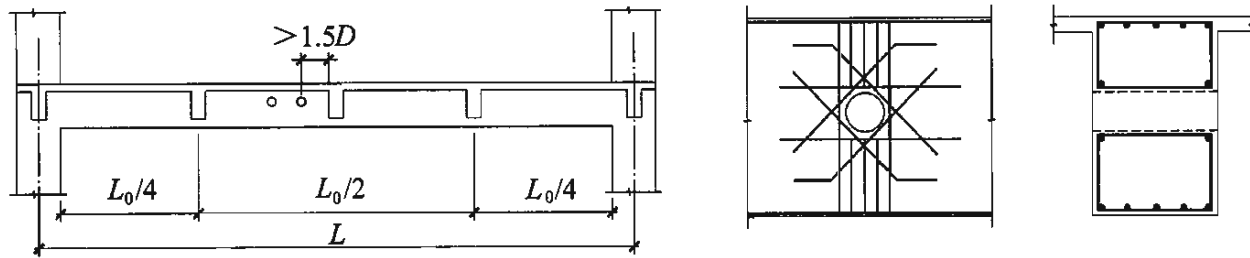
预应力梁上开圆形孔及加强构造
